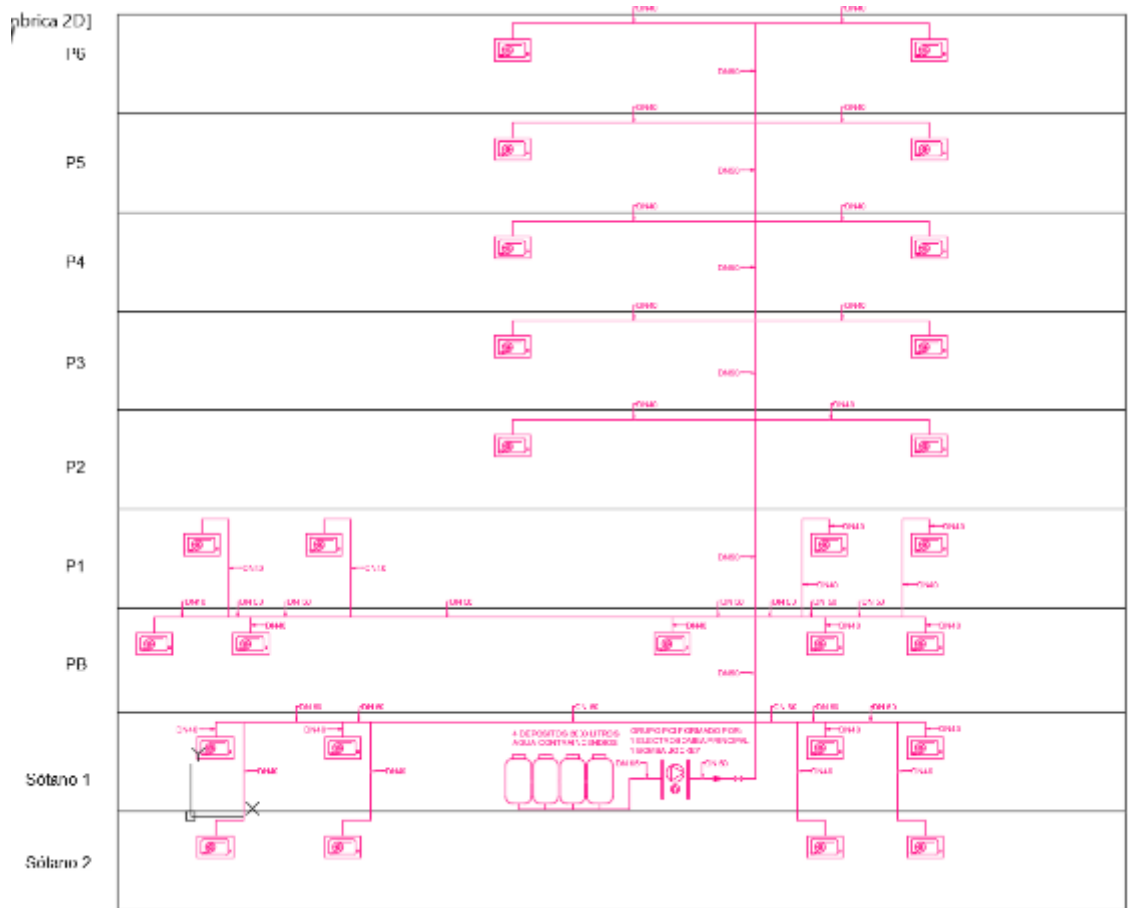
Esquema Vertical Red 27 BIEs por plantas. Planos del proyecto
